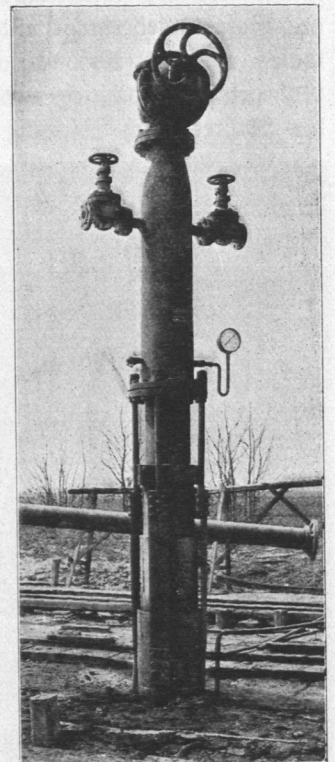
Endgültiger dichter Verschluss der Bohrung.
